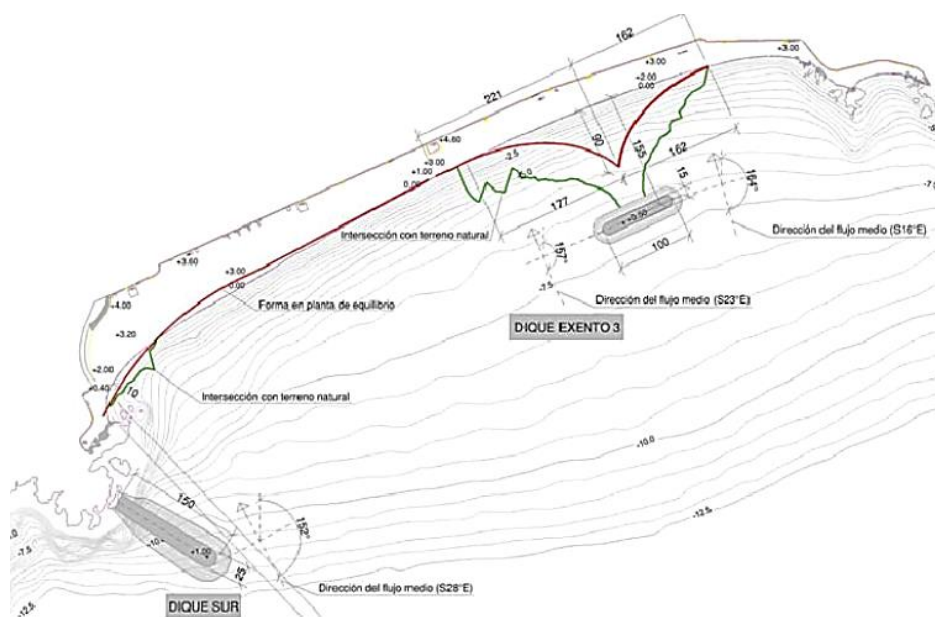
Vista en planta del dic exempt de l'alternativa 6 (Iberport Consulting, 2008)
